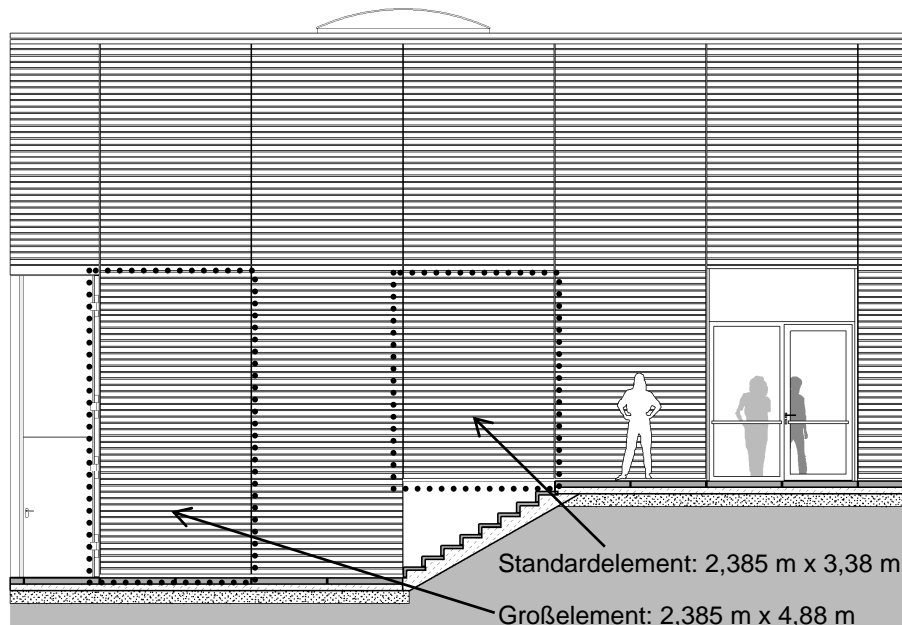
Fassadenausschnitt Nordseite – Elementtypen
